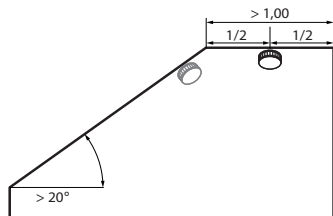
gerade Montagefläche mindestens 1 m lang und 1 m breit
